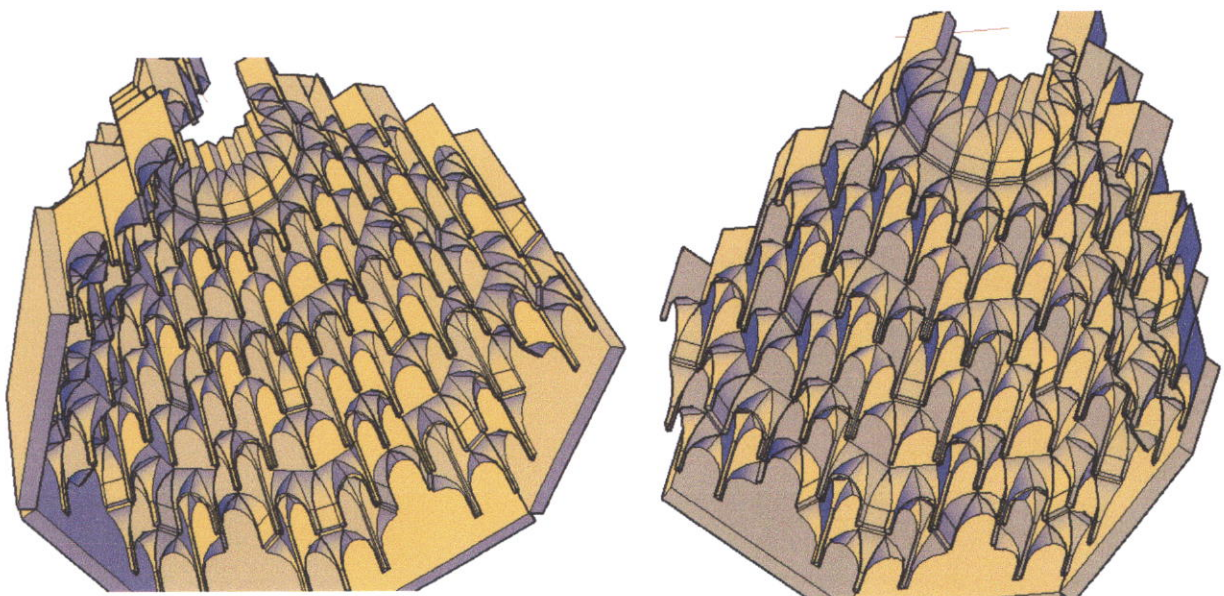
étape 02 du montage des pièces de Mouqarnas projection et 3d dessiné par l'auteur
